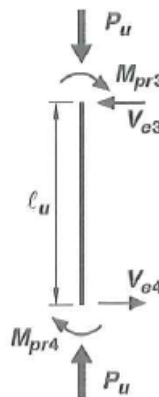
Columna pórtico especial (Imagen ACI 318-19 18.6.5.1)
